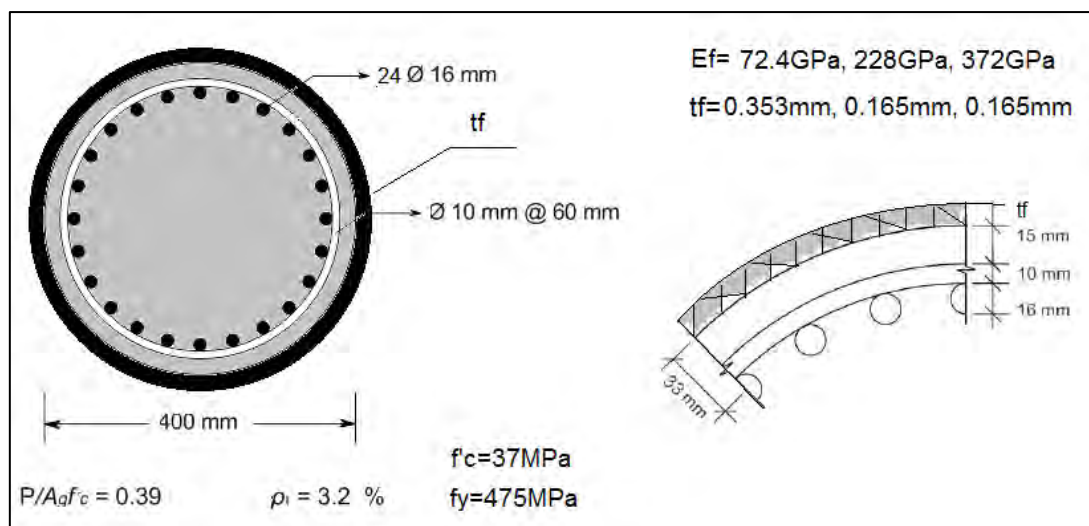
Sección circular de concreto armado de diámetro 400mm forrada con FRP de varios tipos (CF-130, CF-530 y EG-900)
